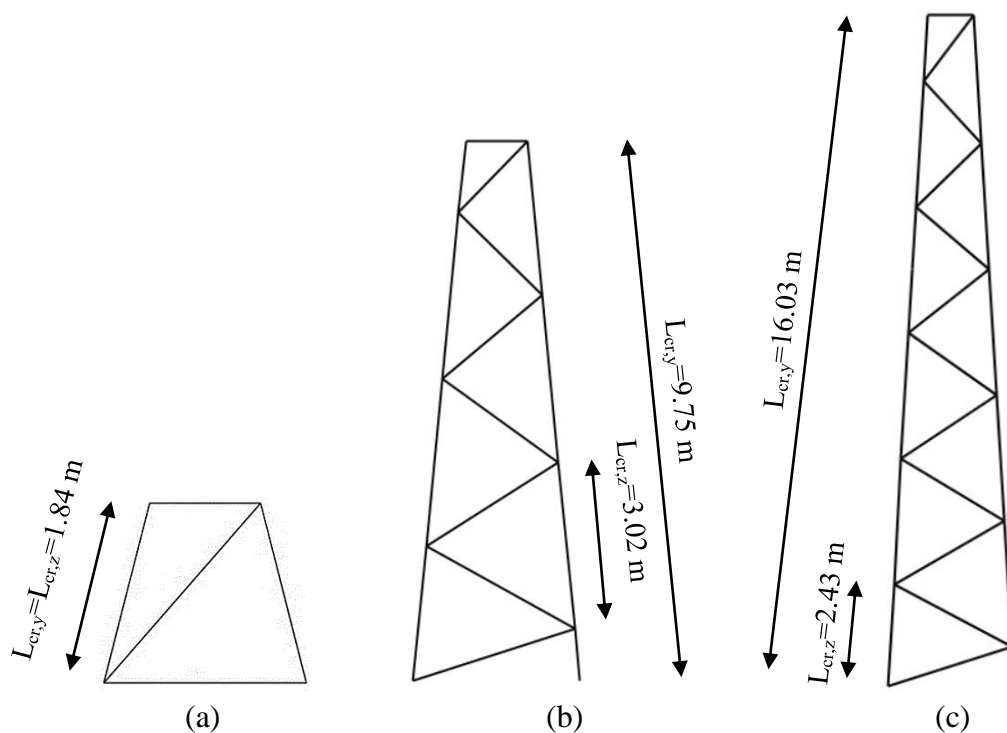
Comprimentos de Encurvadura: (a) Pilar P1; (b) Pilar P2 (c) Pilares P3, P4, P5 e P6
